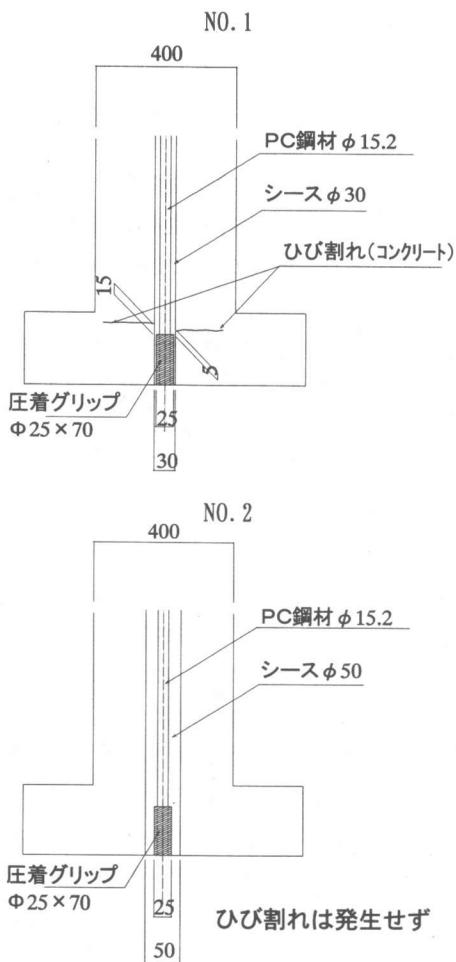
供試体の内部ひび割れ状況(単位:mm)
